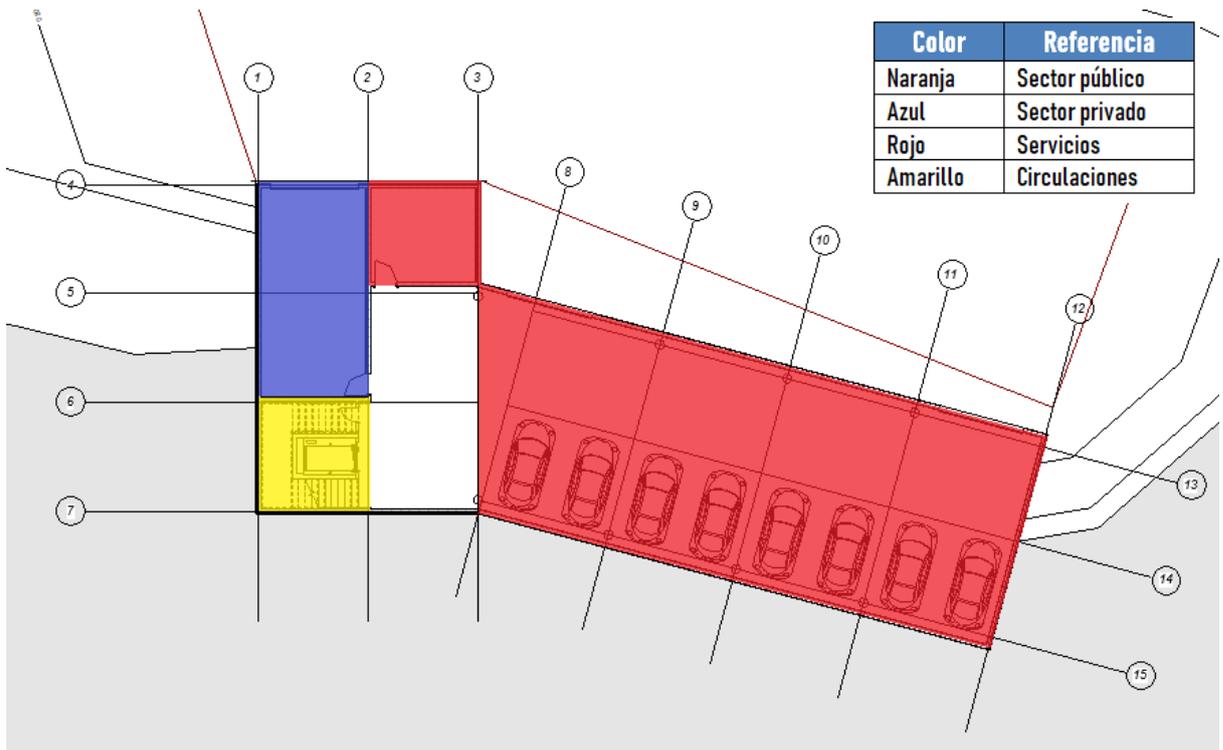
Distribución de los espacios en planta baja. Fuente: Elaboración propia
